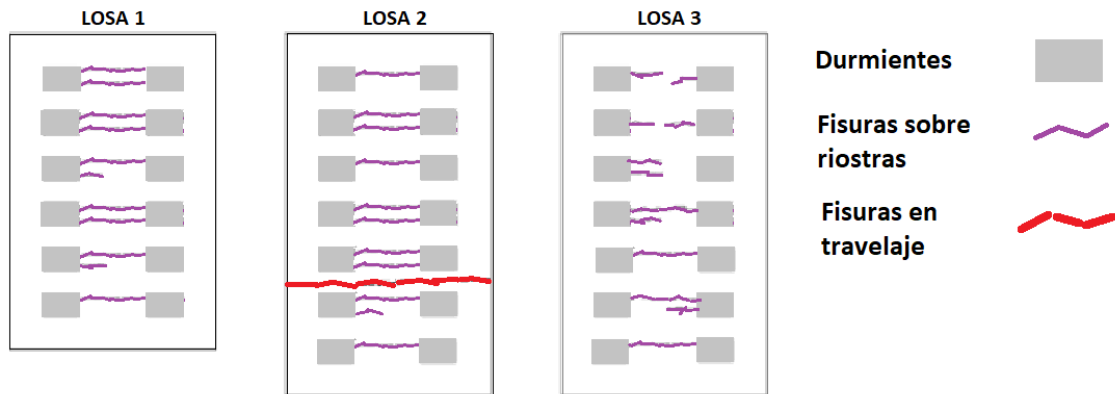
Esquema de fisuras para losas 1, 2 y 3. Extracto de ANEXO 6. Esquema de fisuras en losas analizadas)
